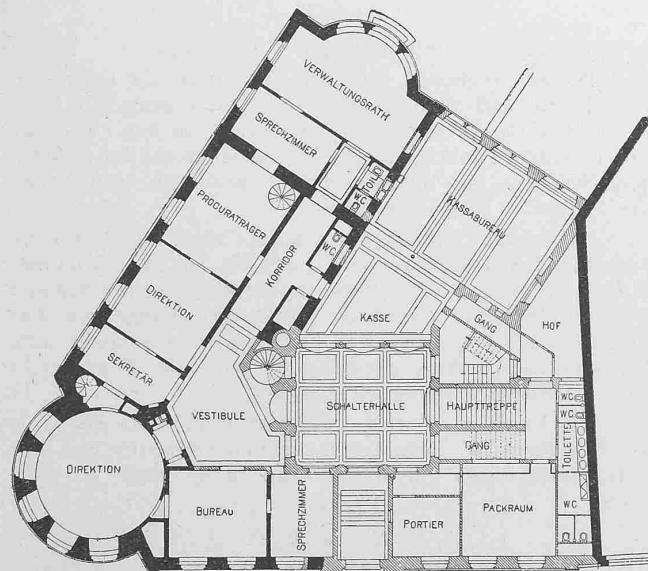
Handelsbank nach dem Umbau. Grundriss vom Erdgeschoß.
